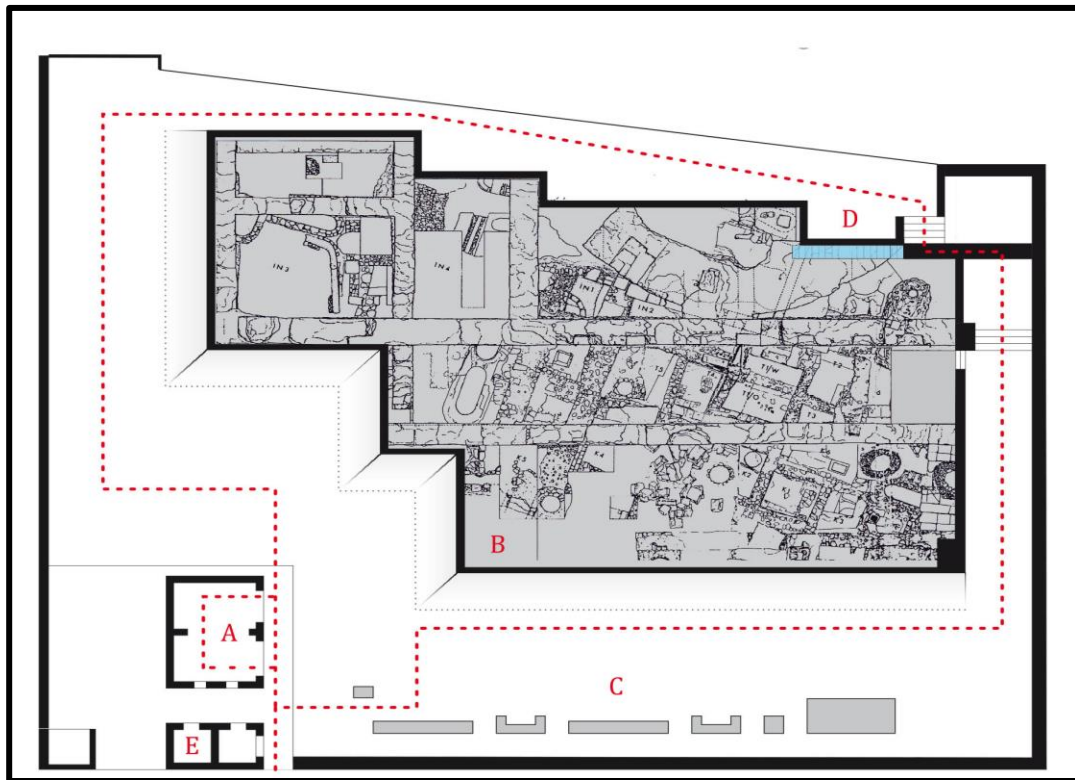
Plan de la restauration du site archéologique : Quartier Didon
